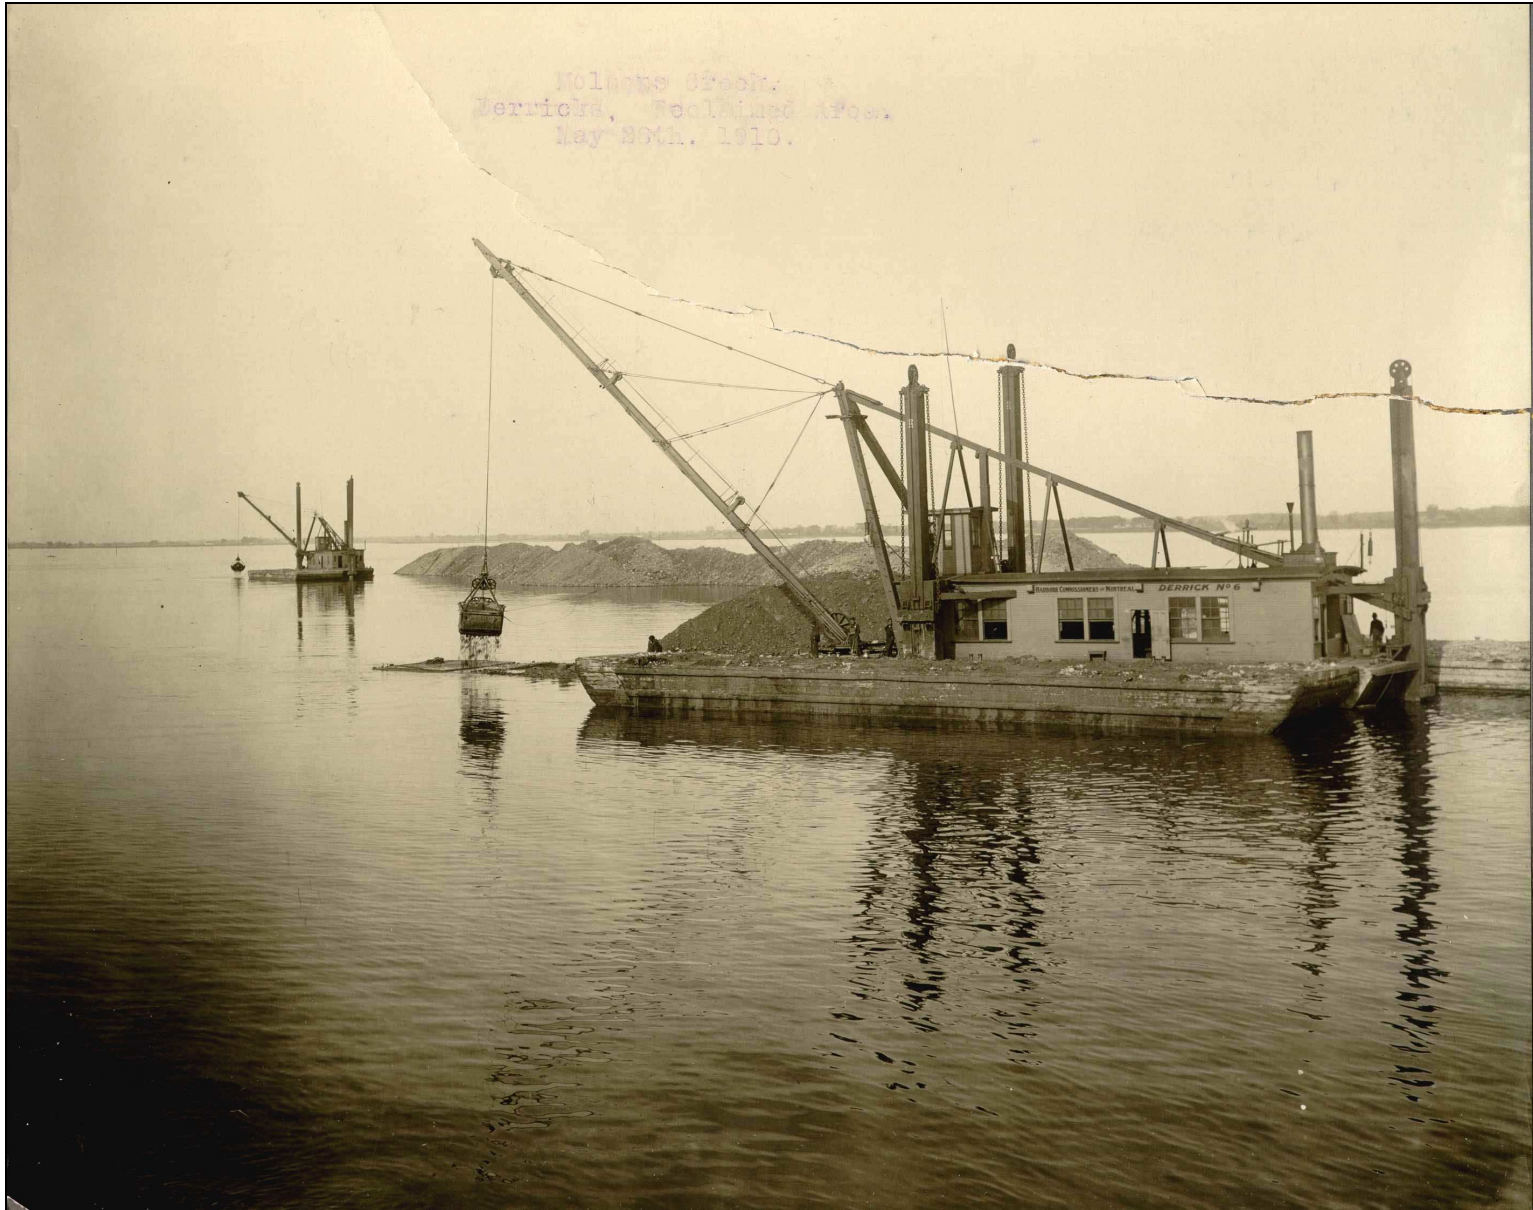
Dragage dans le port à la hauteur du Ruisseau Molson – Travaux nécessités par la construction de cale sèche (1910).
